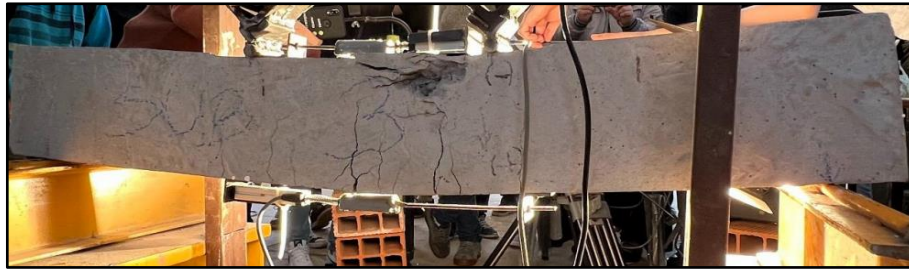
Falla viga Sub-Armada - V03. Vista posterior.
